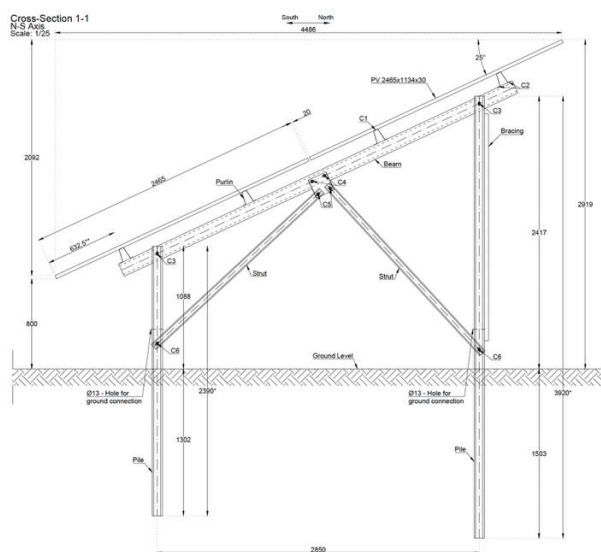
Pormenor das fundações dos usados para os painéis solares
